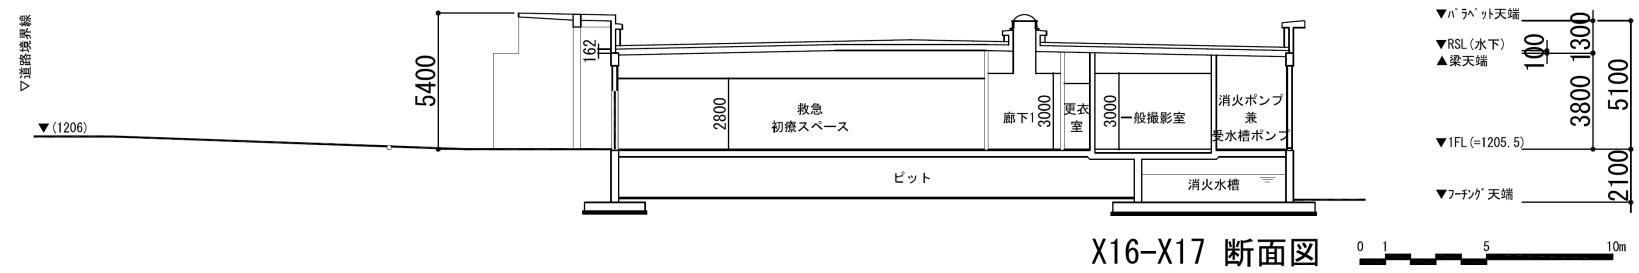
チャンボリー次レベル病院 断面図-1 1/300
